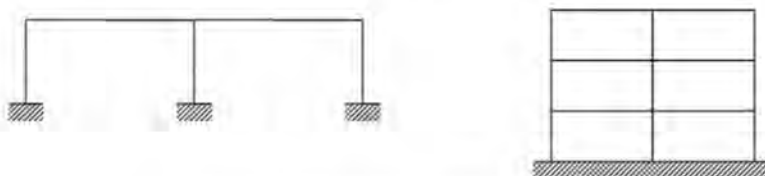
Strutture a telaio con collegamenti monolitici
